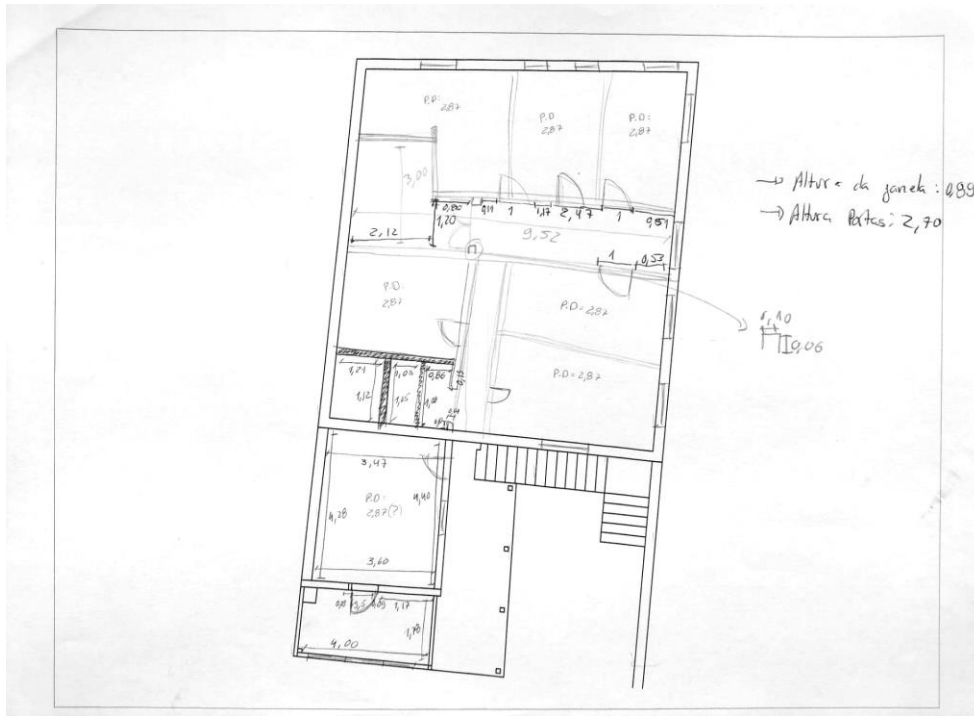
Esboço de planta do piso 1. Fonte: Ana Ferreira
